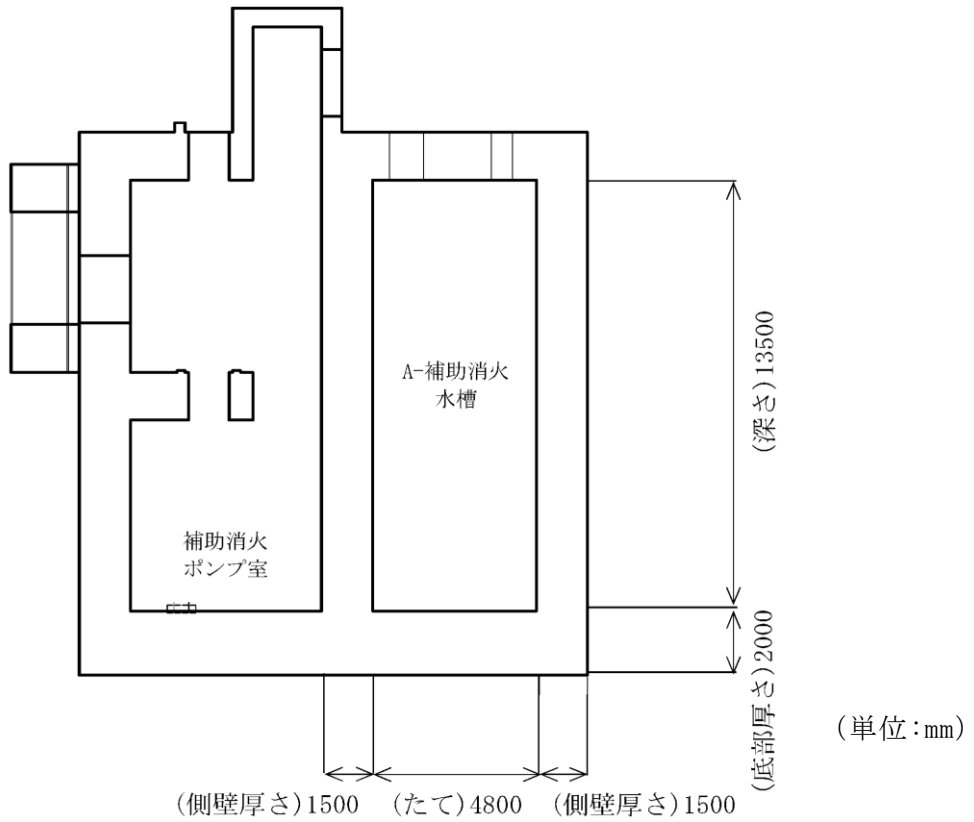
(2) 補助消火水槽 断面図 (B-B 断面)
